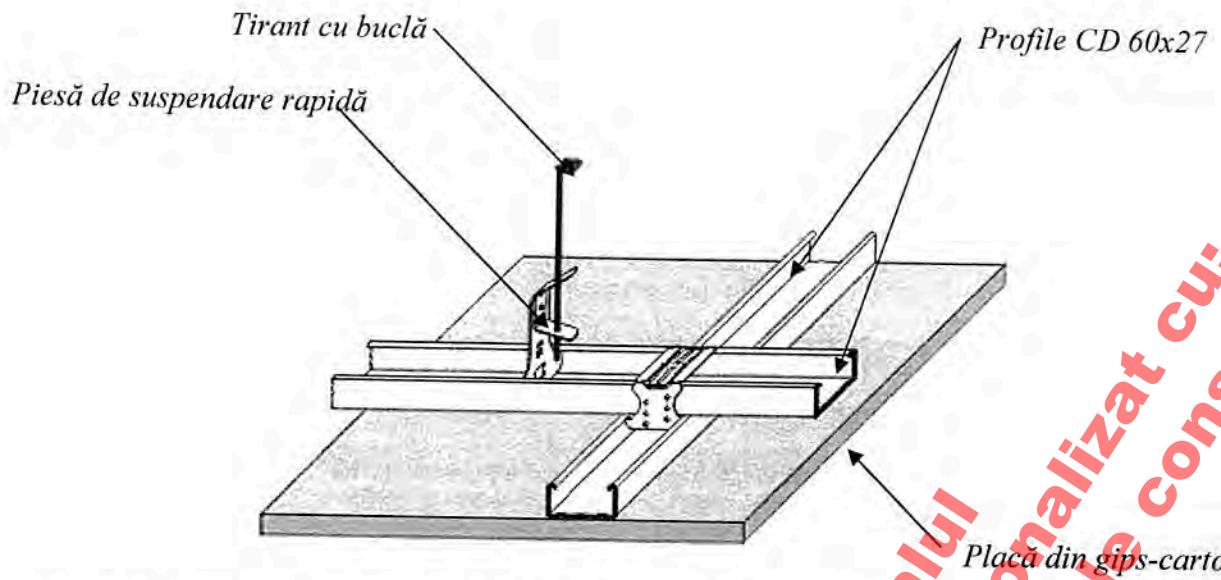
c Detaliu. Tavan din plăci de gips-carton pe structură de susținere metalică alcătuită din rigle portante și de montaj suprapuse suspendat de planșeu cu piesă de suspendare rapidă - fișa tehnică D112
